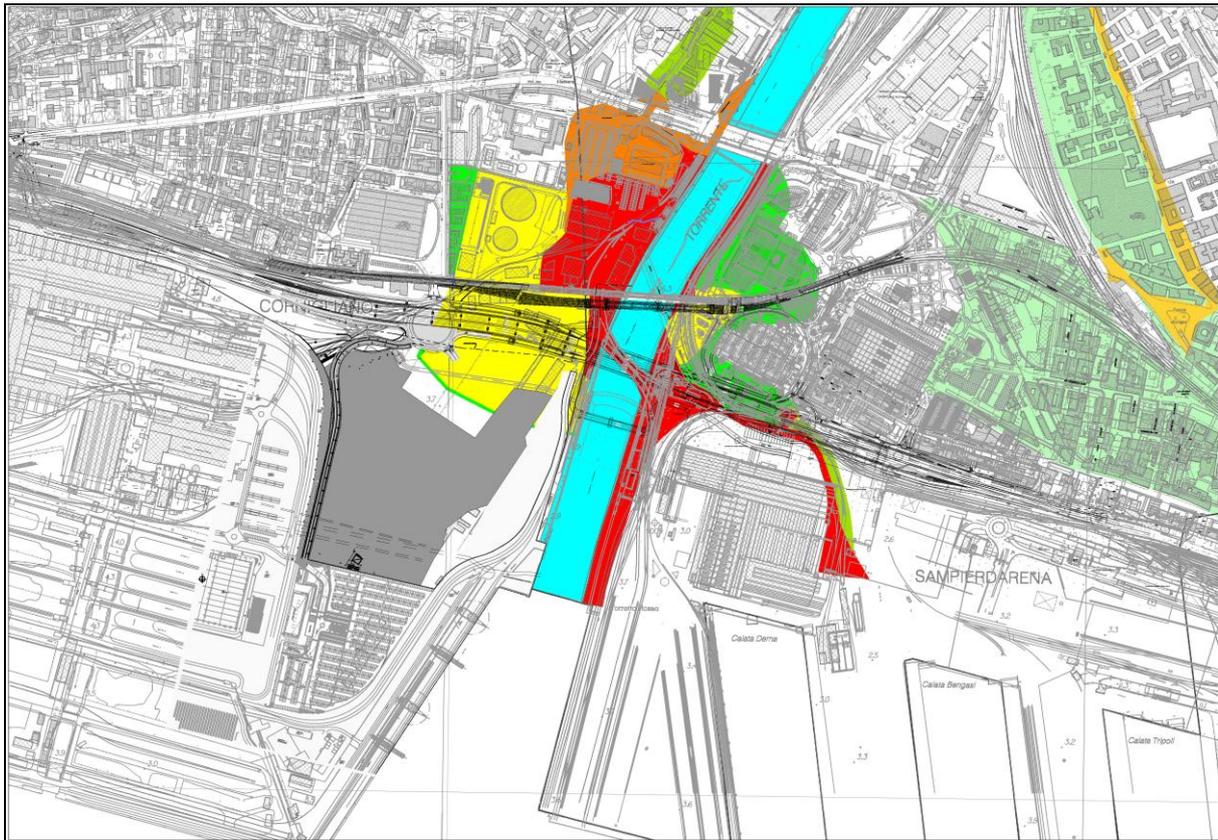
Sovrapposizione tra Planimetria di Progetto e Carta delle fasce di inondabilità
